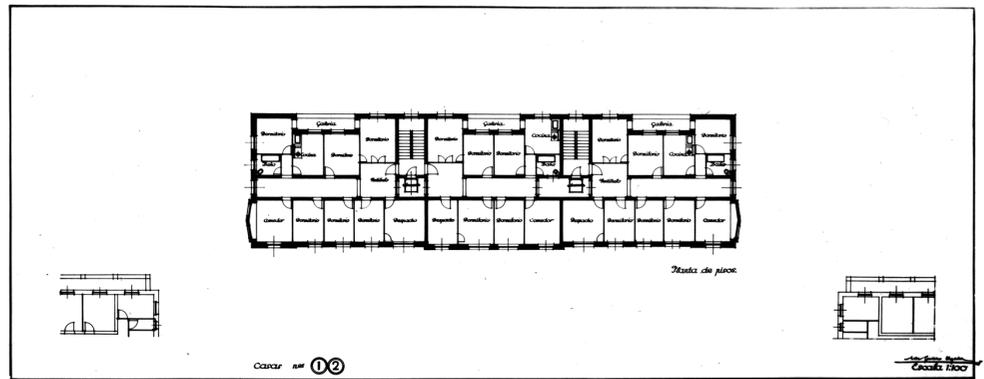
Casa de las Flores, Planta de Pisos y Planta Baja
